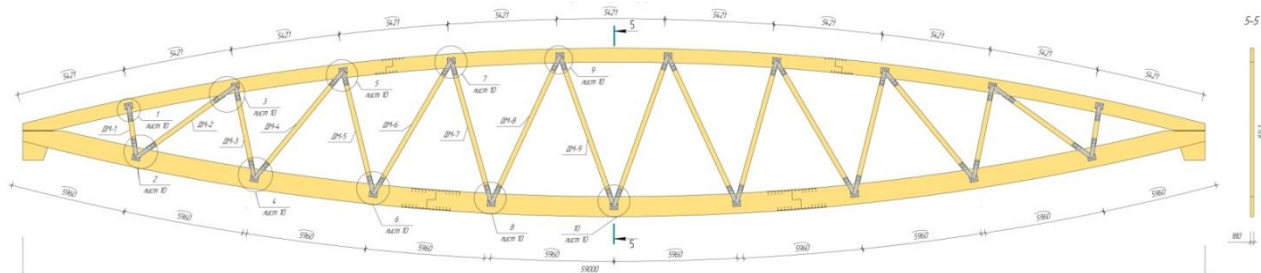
Сегментная ферма с криволинейным очертанием нижнего пояса
